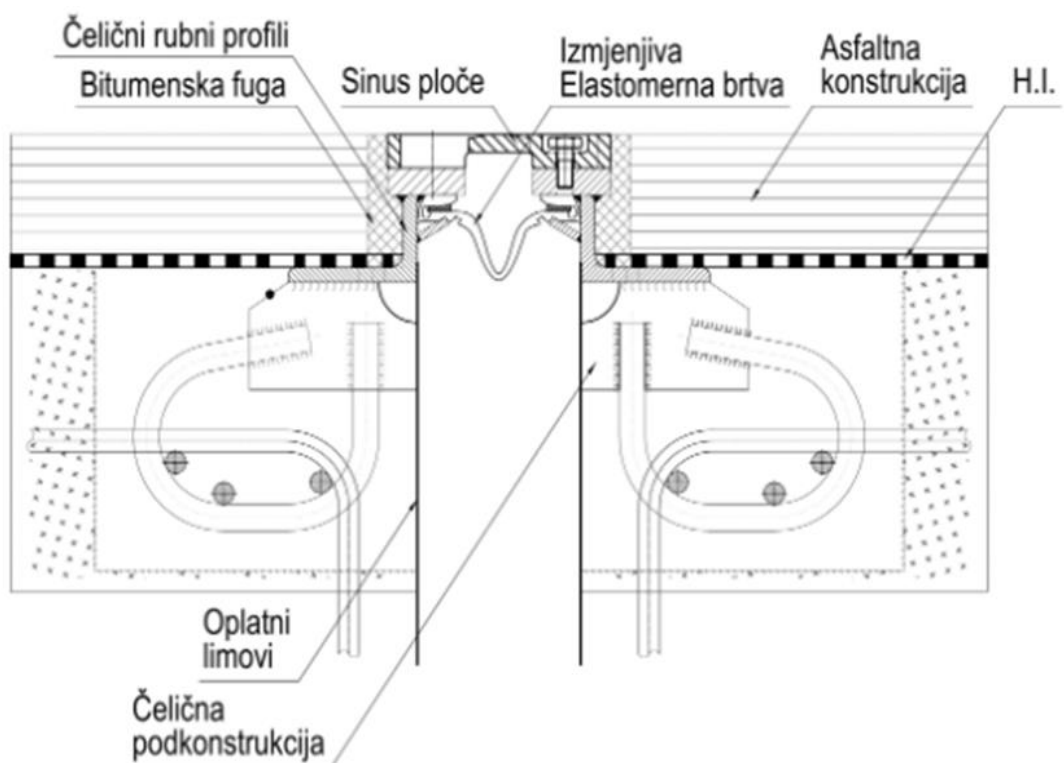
Jednoprofilna prijelazna naprava sa polimer betonom, [4]
